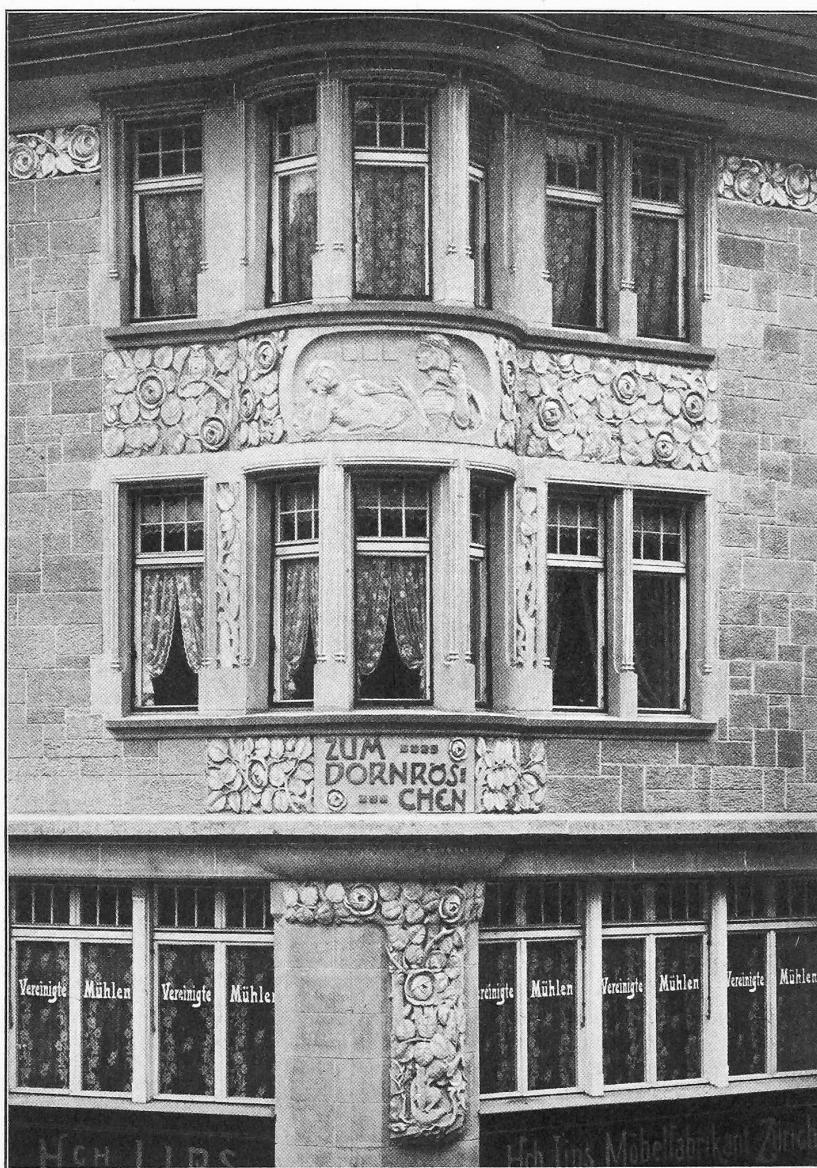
Detail vom Erker an der Ecke der Löwenstrasse und Gerbergasse.
